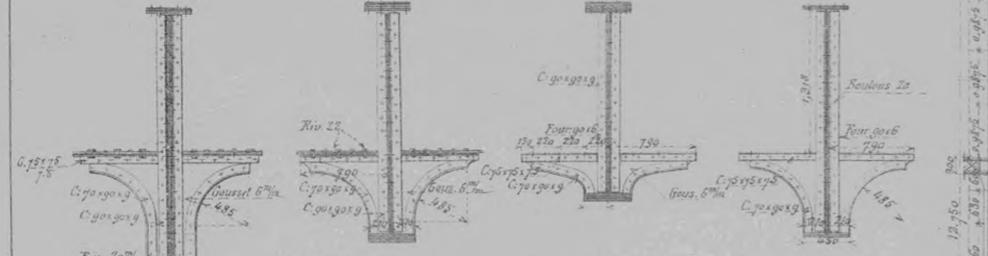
Coupe du pilier suiv<sup>t</sup> k l m n.
